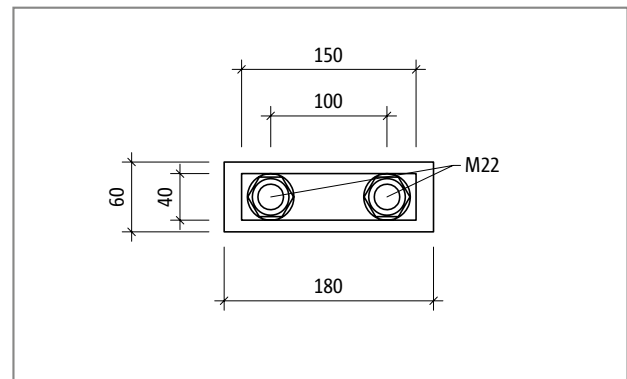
Schöck Isokorb® T type S-N-D16: Doorsnede
